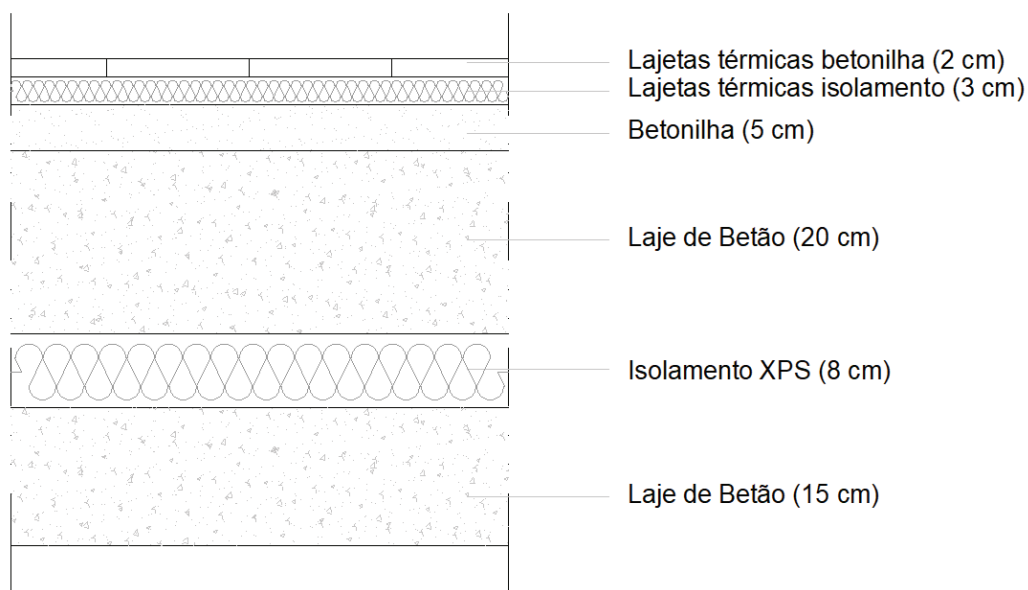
Pormenor construtivo do pavimento interior tipo VII (cota 13.62-Florest)
